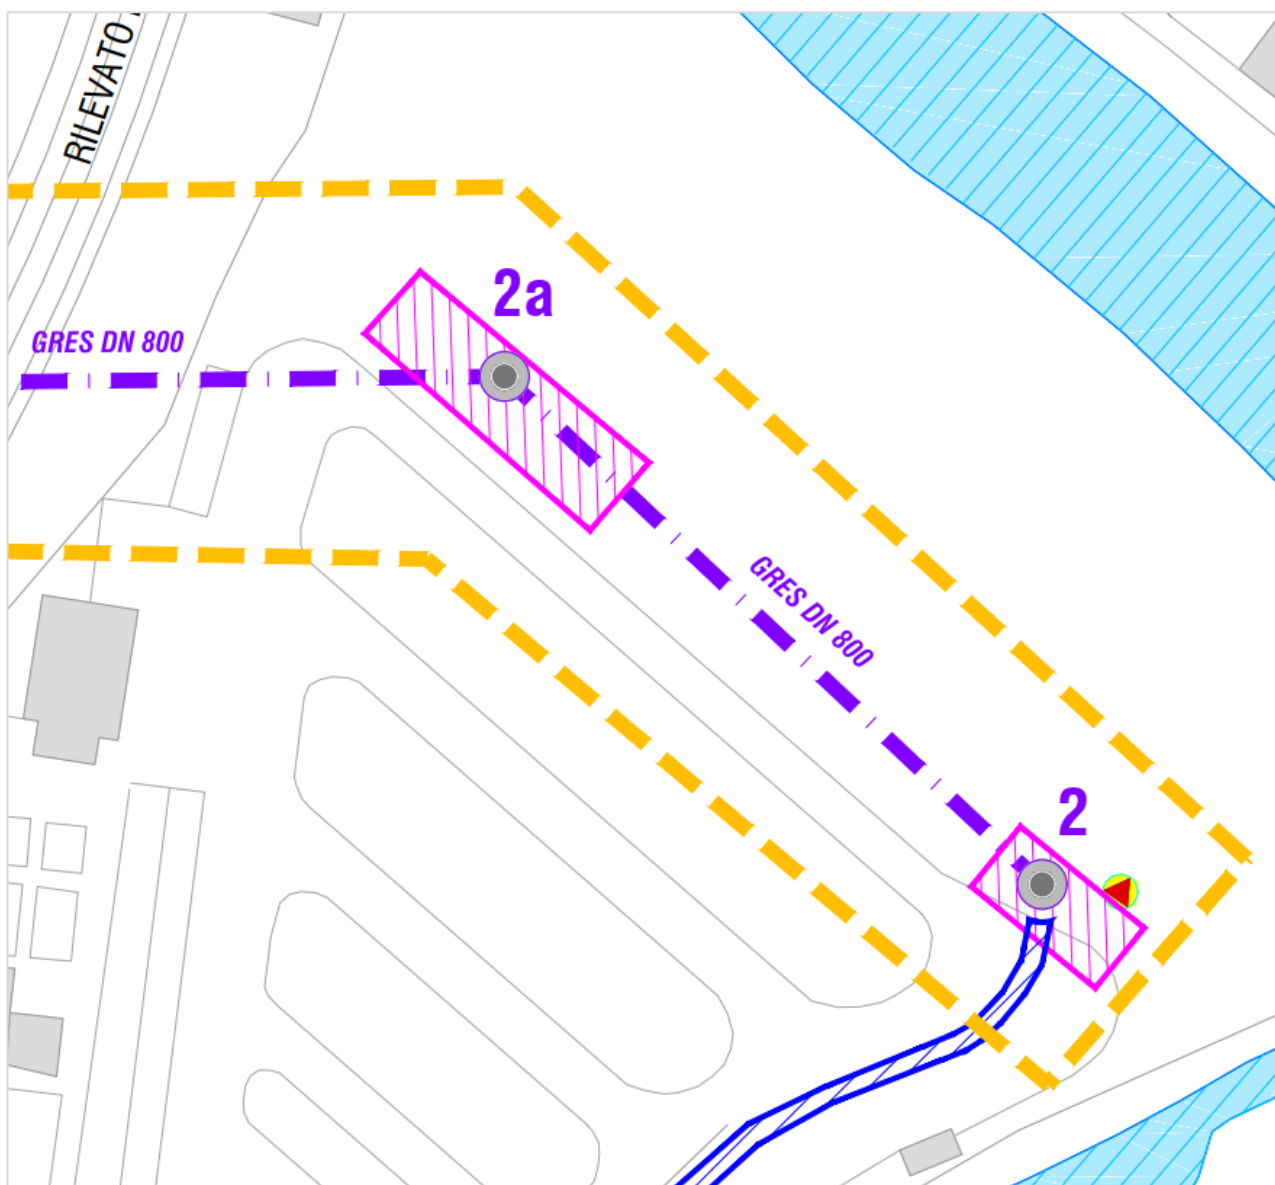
L : Inquadramento planimetrico area cantiere pozzo S2a
